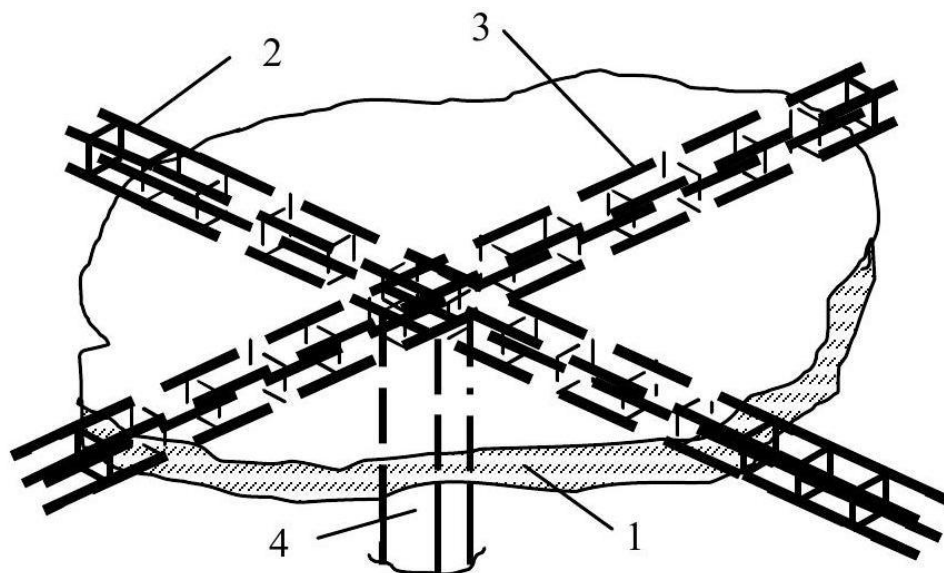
Схема армування фібробетонної плити 1 – плита з фібробетону; 2, 3 – каркаси поздовжнього і поперечного умовних ригелів; 4 – колону
